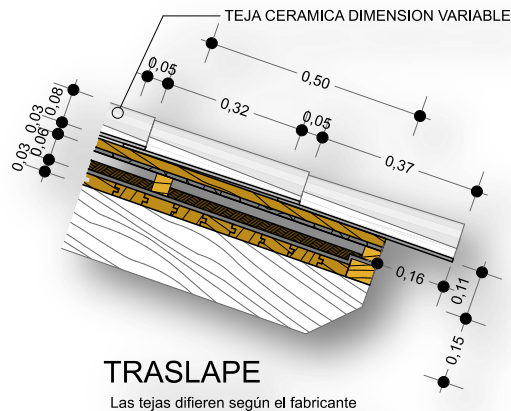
DETALLE DE ALERO Y TRASLAPE
